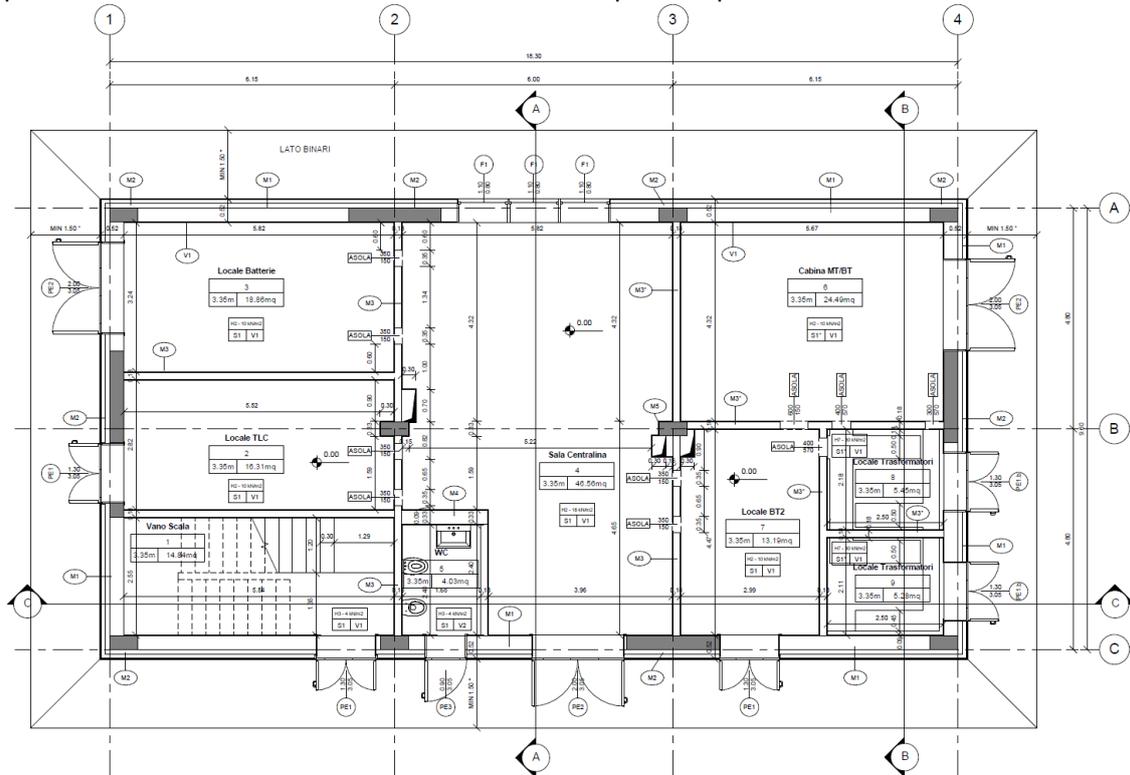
FA01 - Fabbricato ACC Pianta Piano Terra
